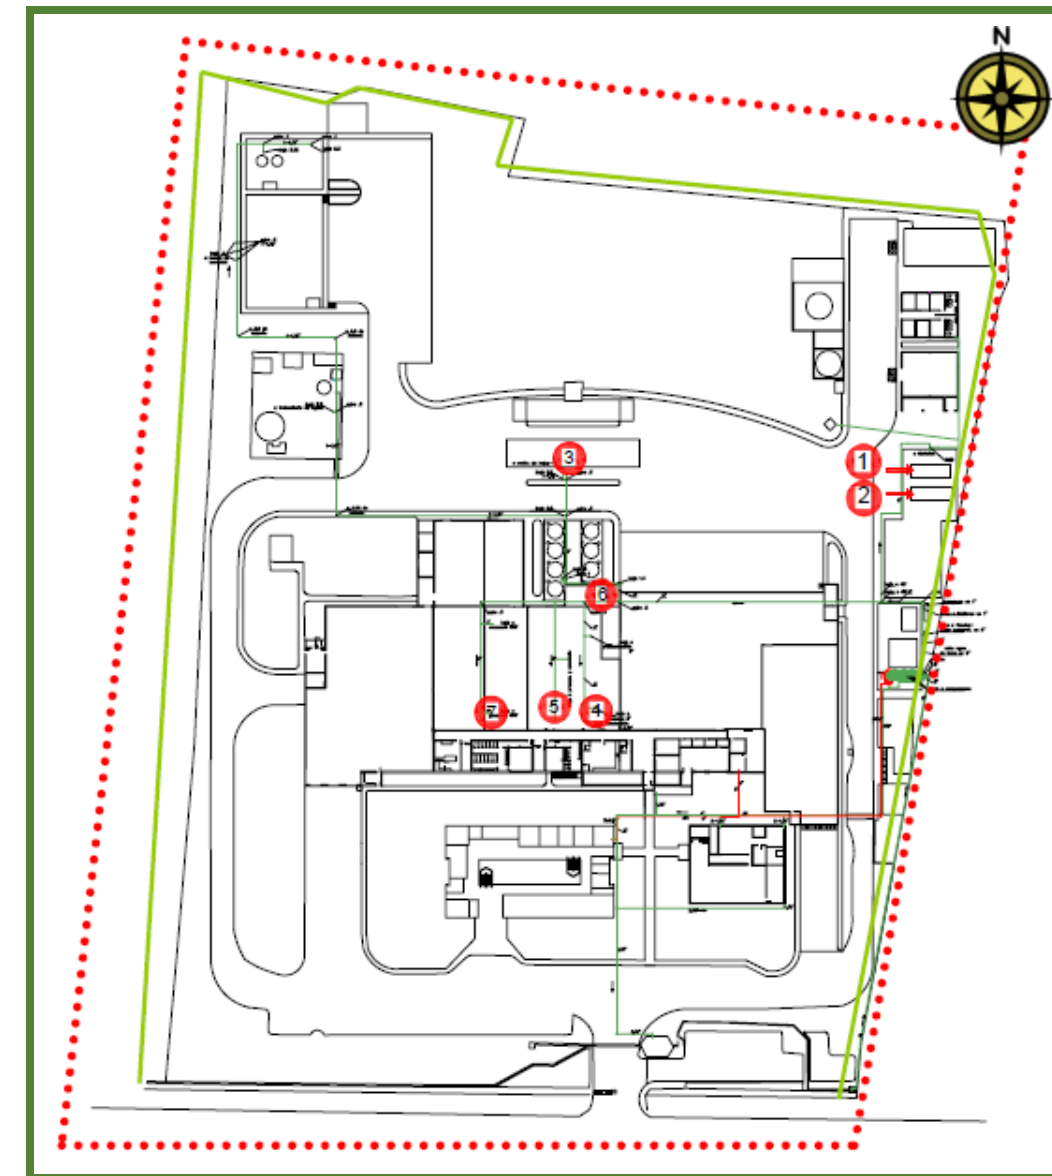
Planta Arquitectónica de planta Industrial Colanta-Funza.
